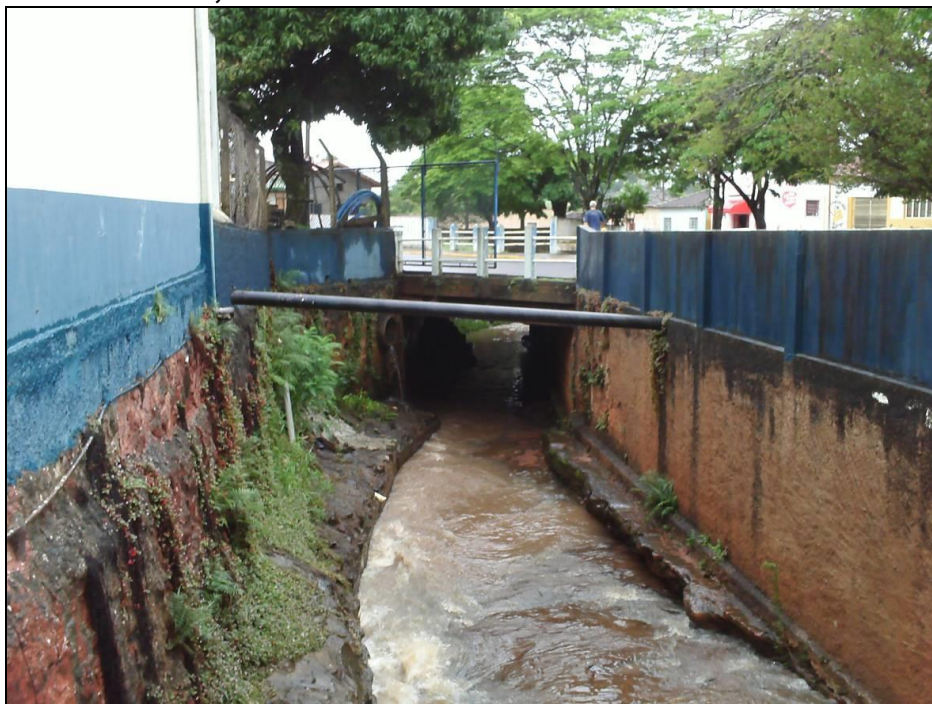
Travessia da R: Aristides Pires (Córr. Lageado) – duas aduelas de concreto de 1m<sup>2</sup> cada
